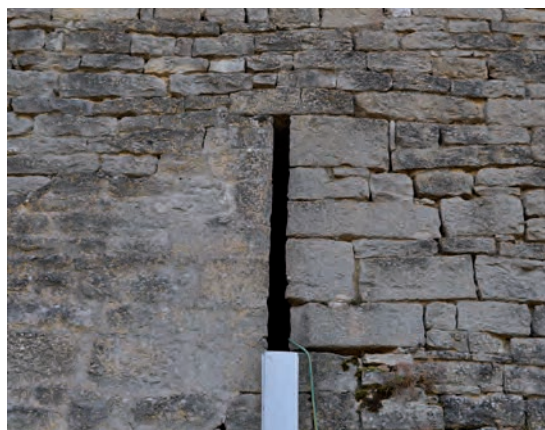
Archère ouest (UM2-1-UC1) en parement extérieur
